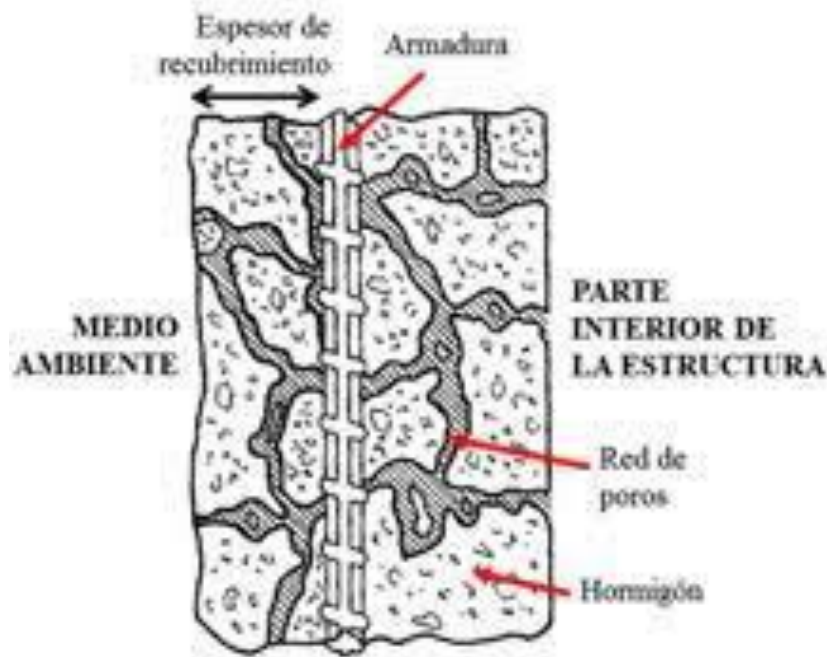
Red de poros en una estructura de hormigón armado. (2016)^[17]
